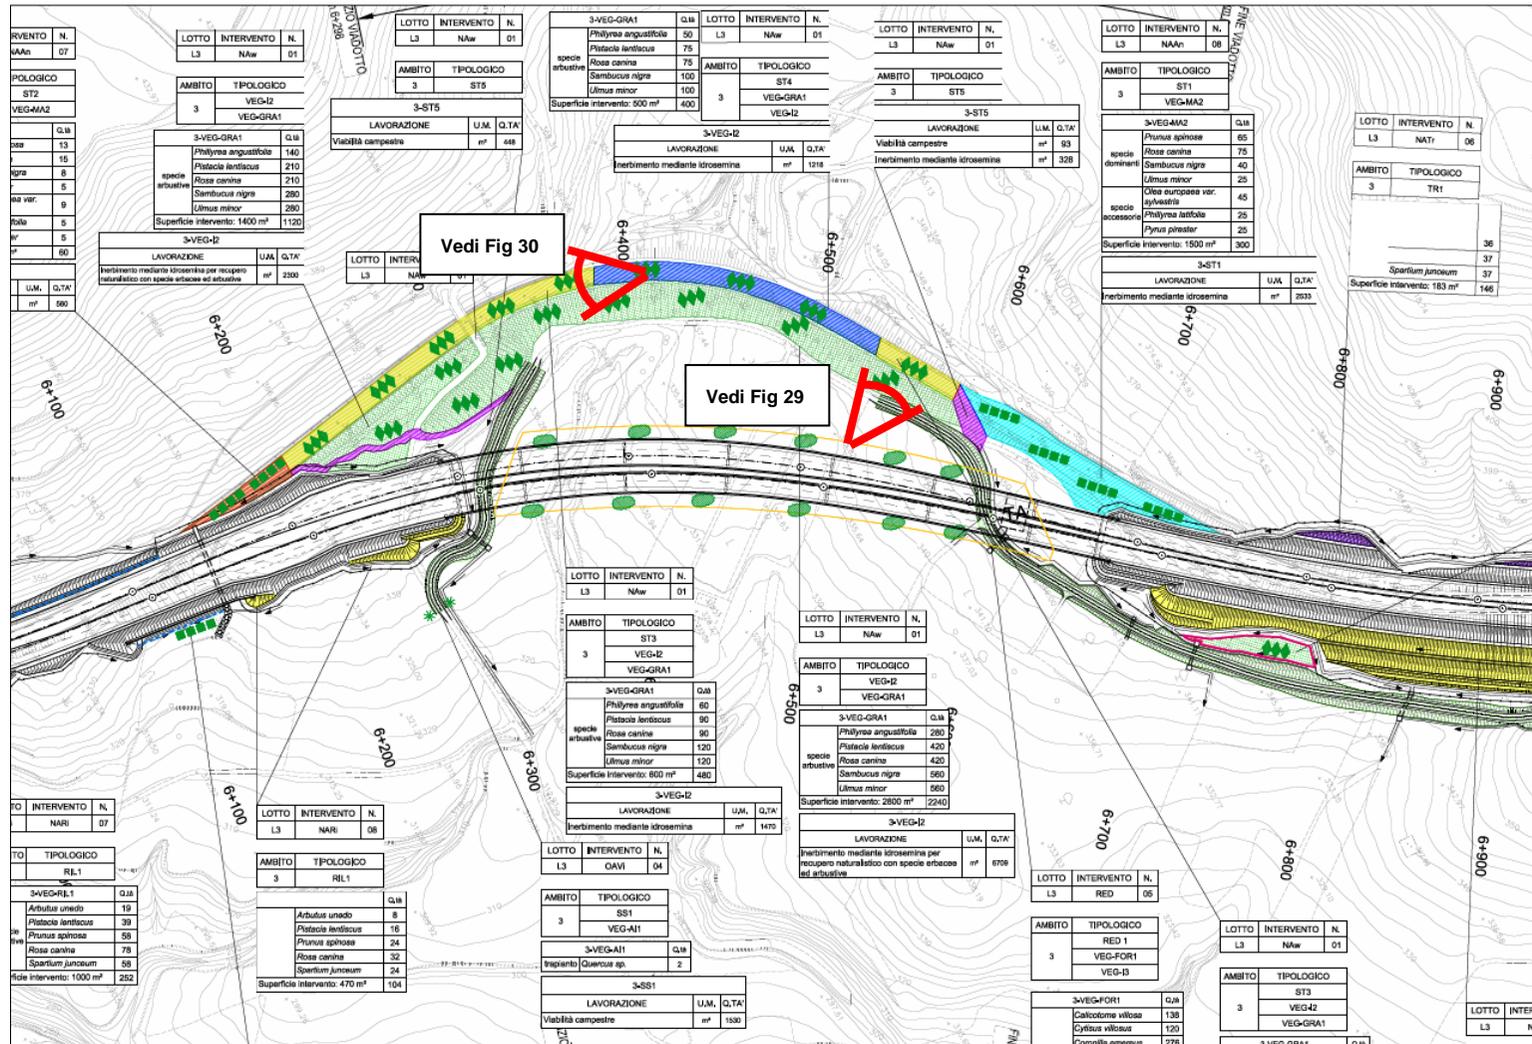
Stralcio planimetrico dell'intervento di naturalizzazione dell'area degradata del Lotto 3 km 6+100 a km 6+700
